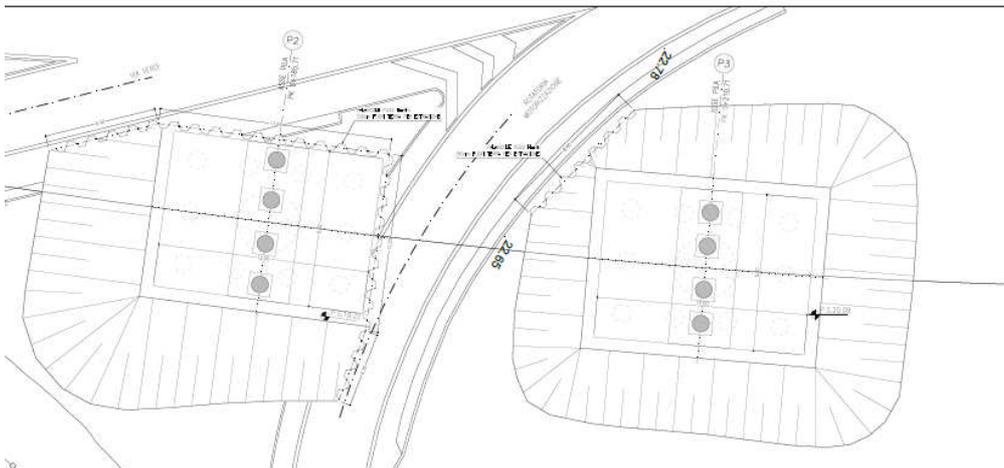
Planimetria opere provvisorie pila 2 e pila 3
